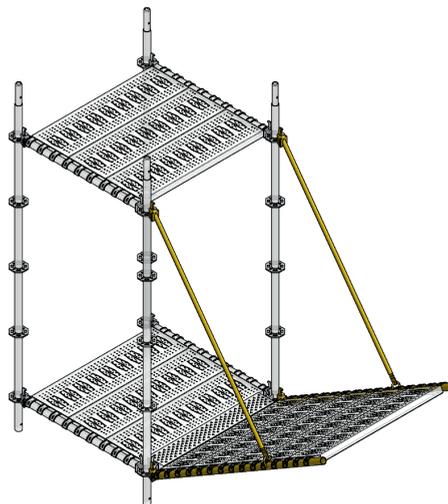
Sistema modulare con parasassi (Fonte: Marcegaglia Buildtech)
